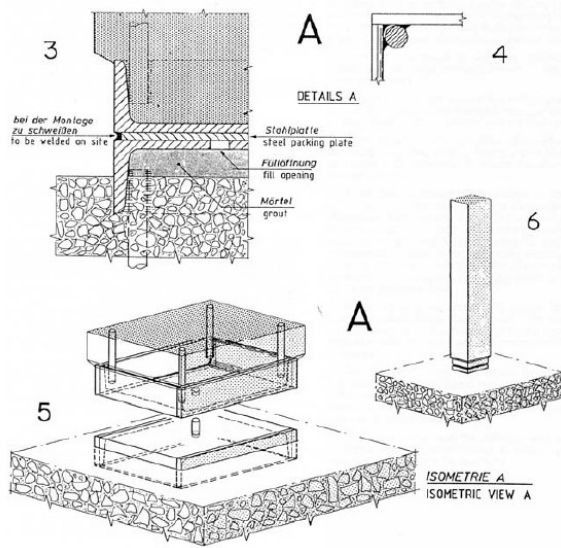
Ligação por soldagem a chapa (Stupré, 1981)
